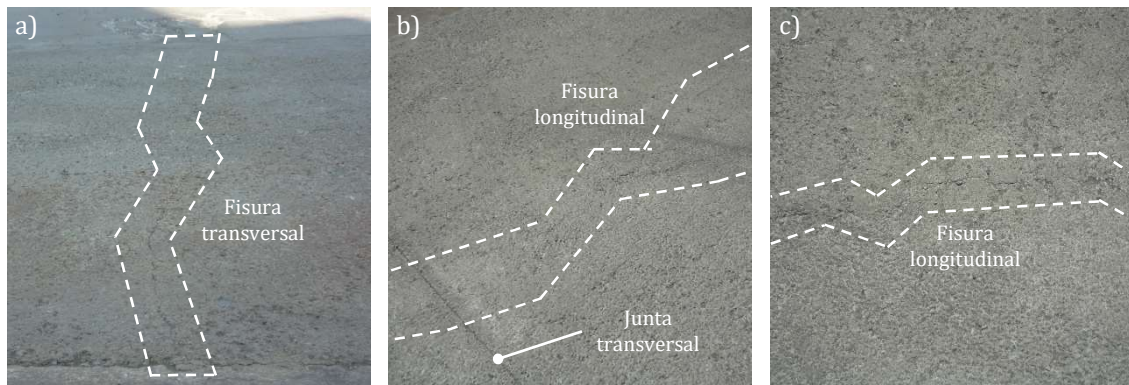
Fisuras de retracción: transversal (a), longitudinal (b) y detalle (c).
